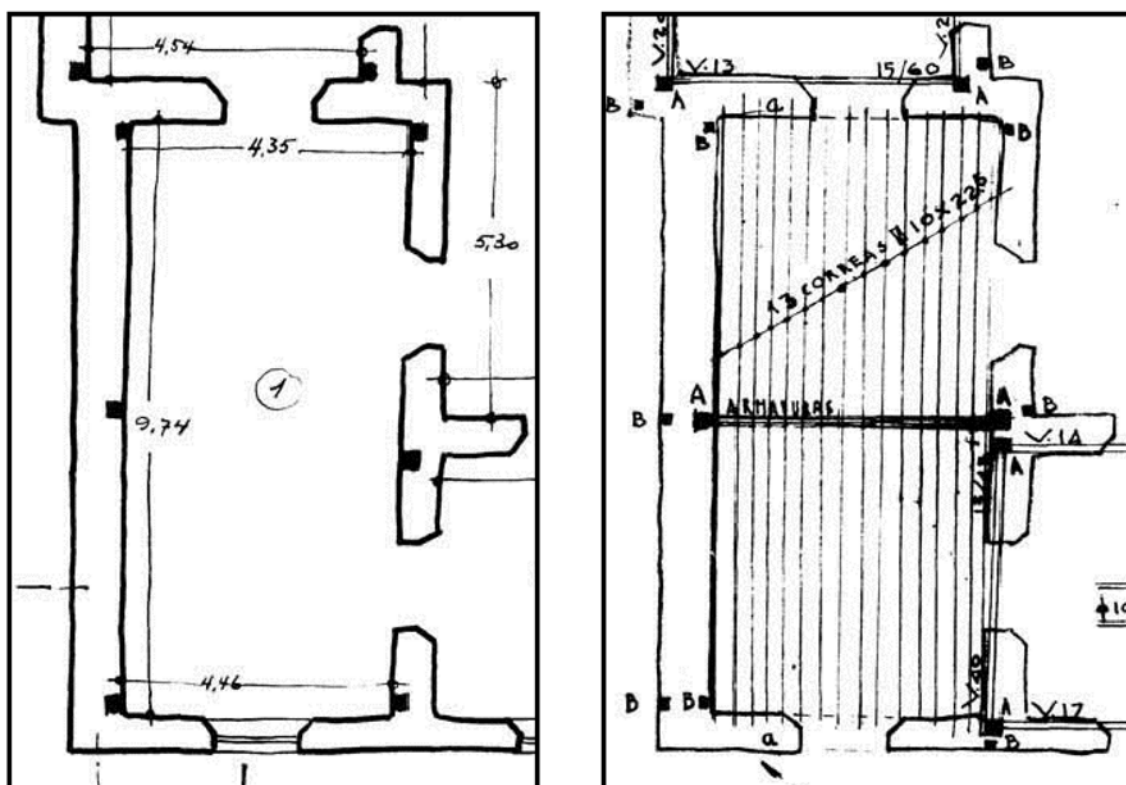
Izquierda: Detalle del plano presentado por Buschiazzo (CeDIAP 19 de febrero de 1944). Derecha: Detalle del plano de estructura calculado por Rolando (CeDIAP marzo de 1944); la A corresponde a las columnas mientras que la B se refiere a los parantes. Fuente: elaboración propia a partir de planos del CeDIAP.
